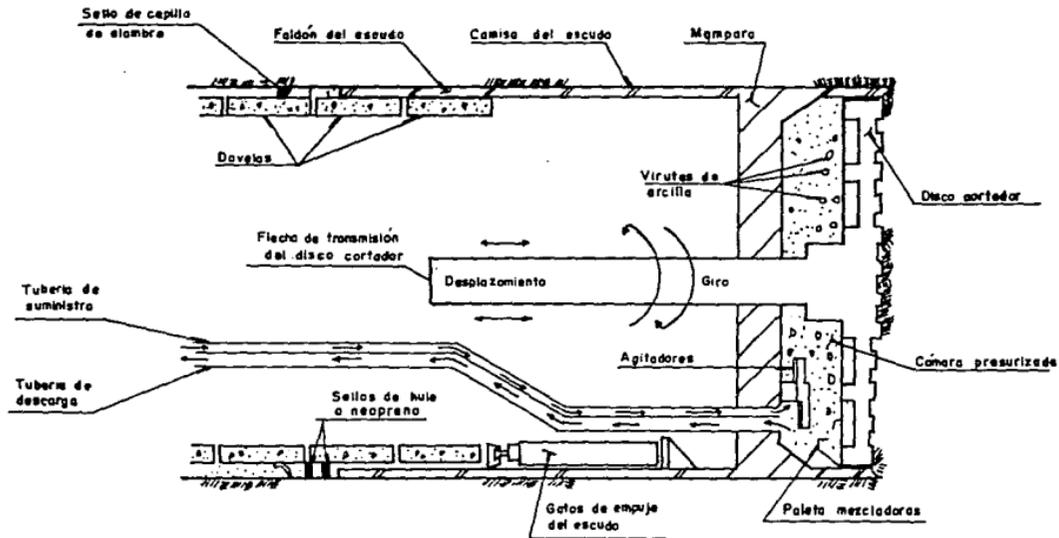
EXTRACCION DEL MATERIAL EXCAVADO
